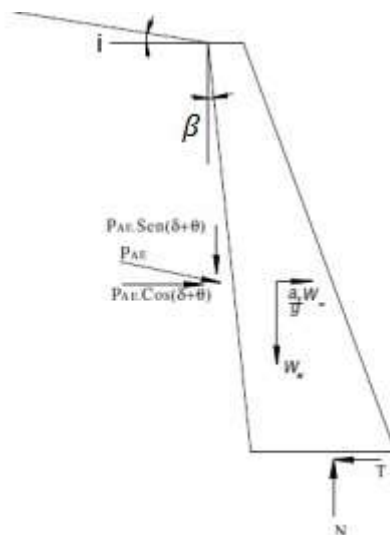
(Muro de gravedad bajo la acción de fuerzas pseudoestáticas)
